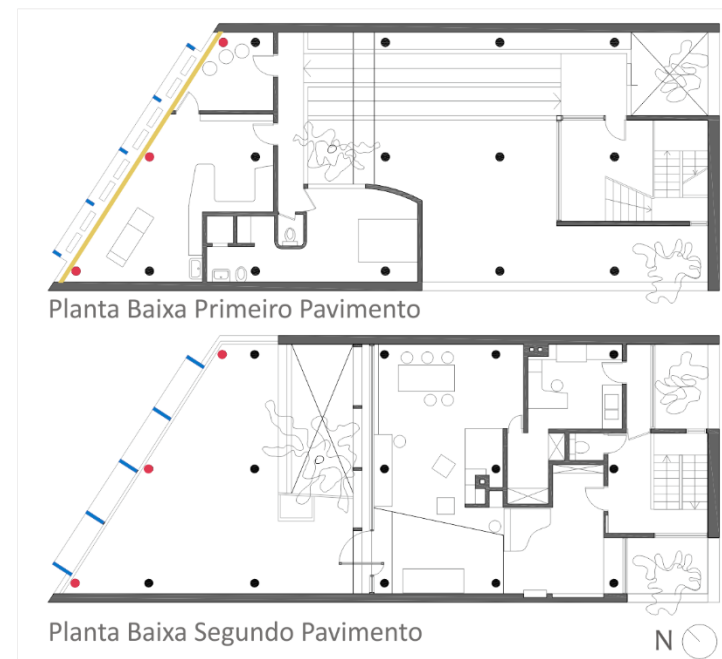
Casa Curutchet. Planta Baixa ilustrando as 3 melodias. Em azul, o *brise soleil*, em amarelo o *pan de verre* e em vermelho os pilotis da estrutura. Fonte: Autora, 2016.
